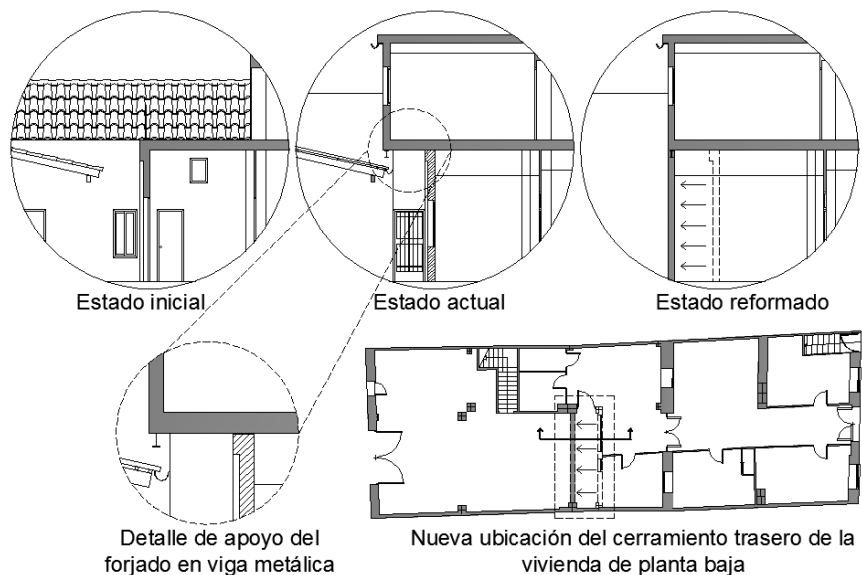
Detalle de la ampliación de la vivienda de la planta baja y nueva ubicación del cerramiento trasero. 2014. Elaboración propia.
